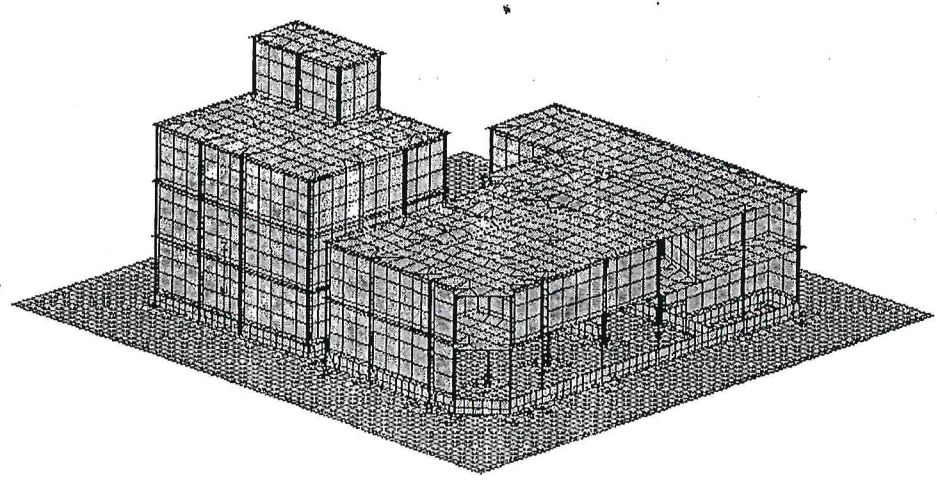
Расчетная схема существующего здания с пристройкой 3х этажного здания в одном уровне
